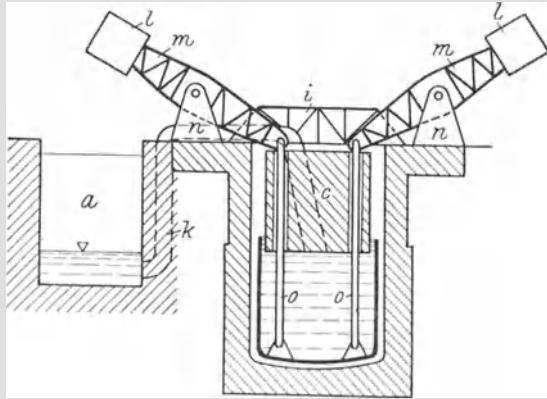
Mit Gegengewicht bei einfacher Schleuse.
